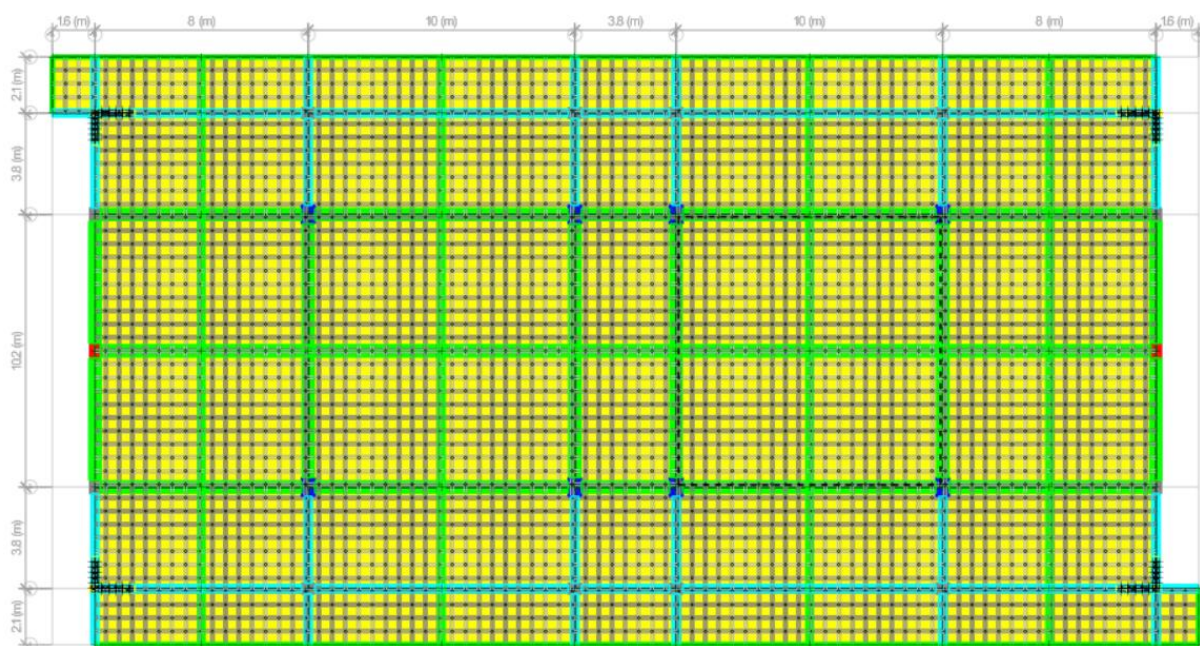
Vista en planta primer piso de la edificación Haga clic o pulse aquí para escribir texto..
